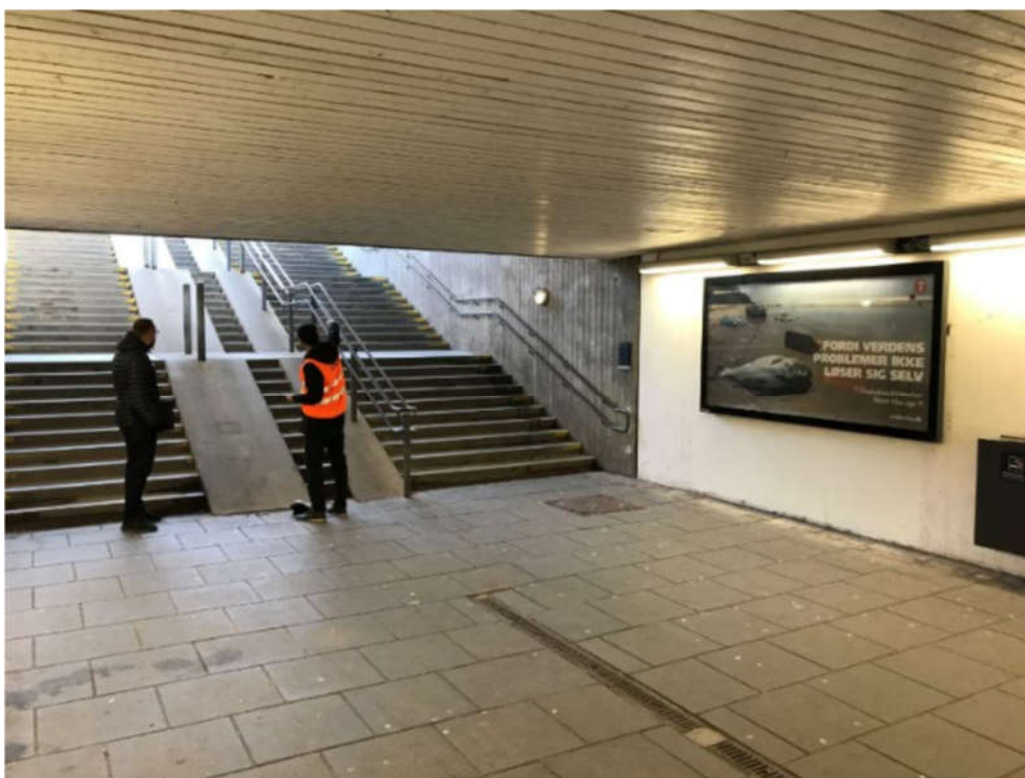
Område for elevatorplacering ved Centrumgaden, syd for banen
